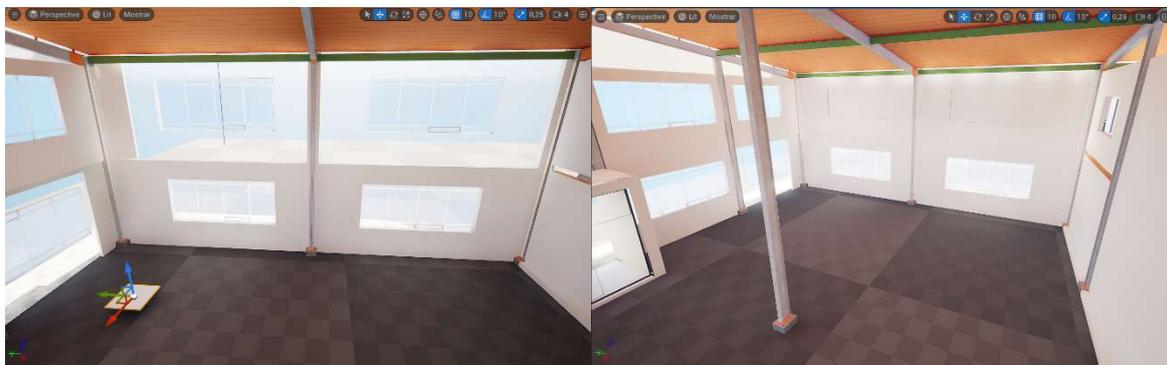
Arreglos estructurales en ventanas superiores interiores. Fuente: Elaboración propia.
